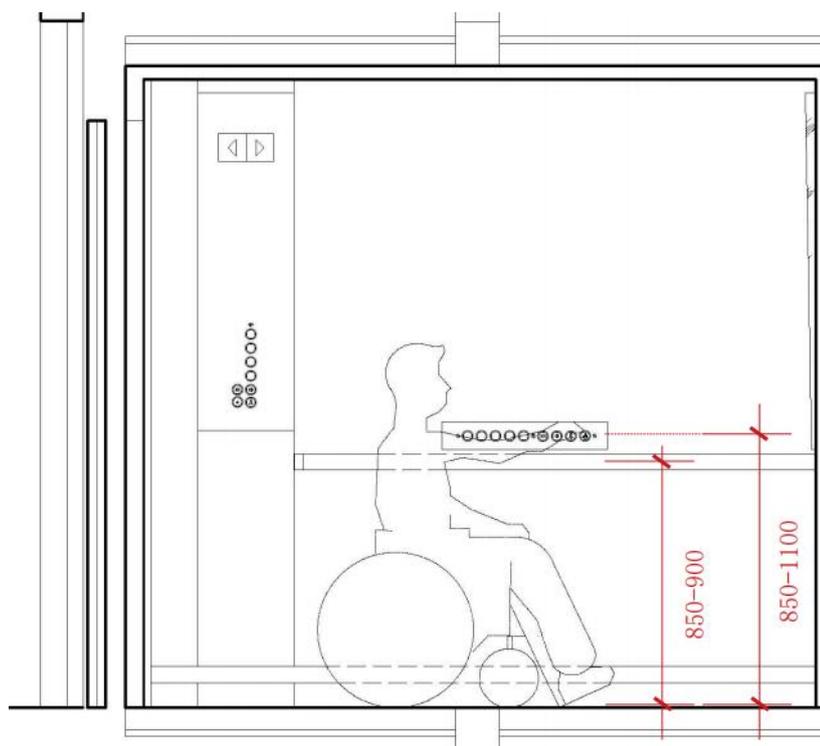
轿厢内部配置示意图（单位：mm）
